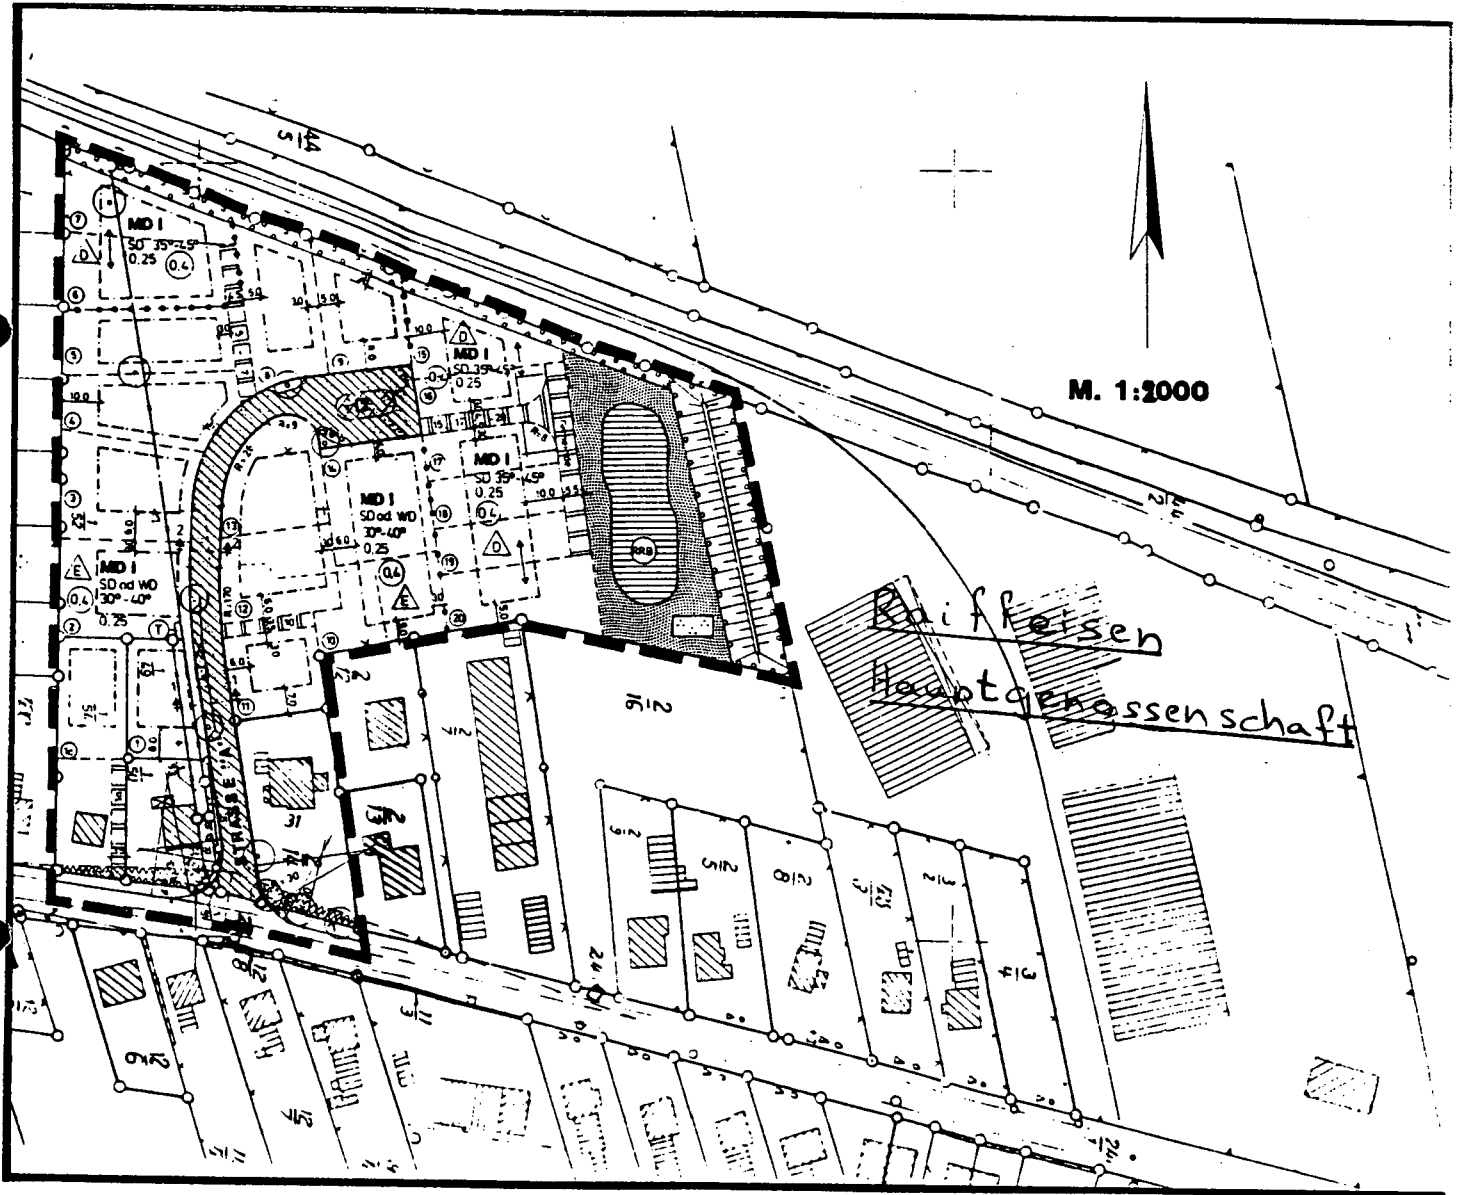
Bebauungsplan Nr. 4 der Gemeinde Fahrenkrug
